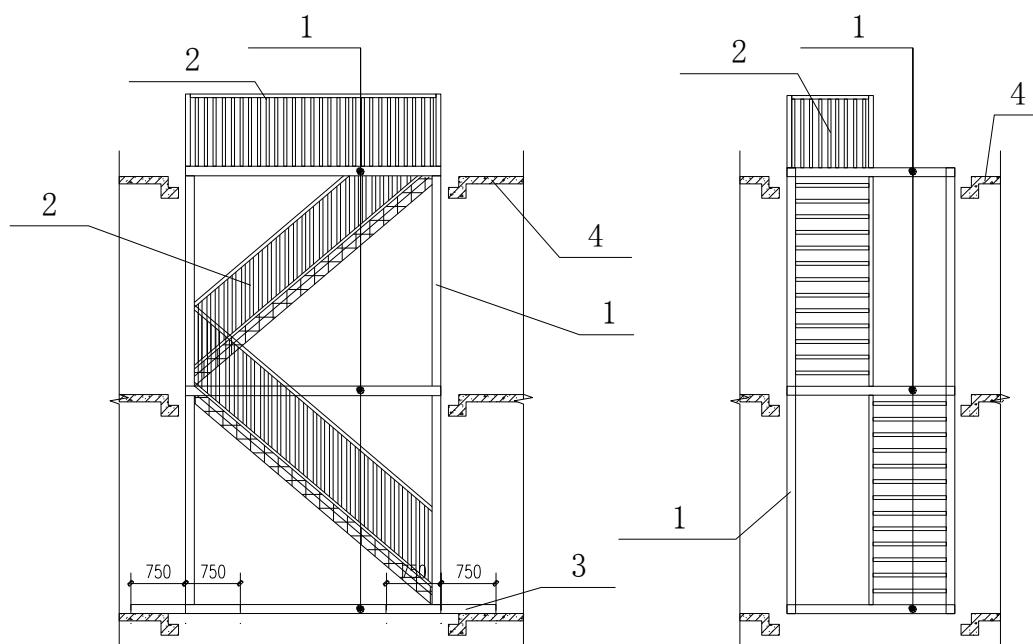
楼梯间整体平台防护示意图（单位：mm）
